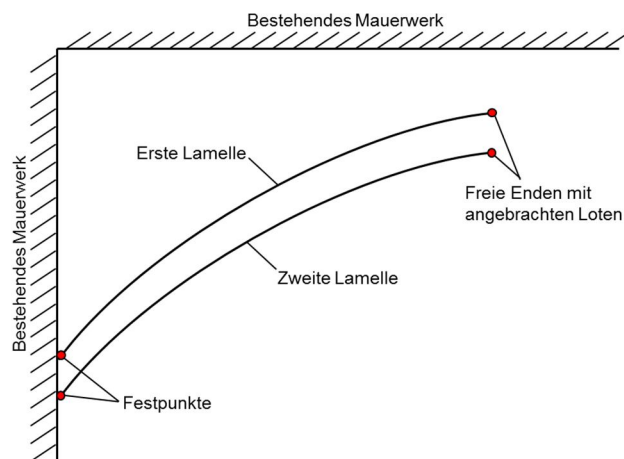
Grundrissdarstellung der Lamellen im Büroraum
